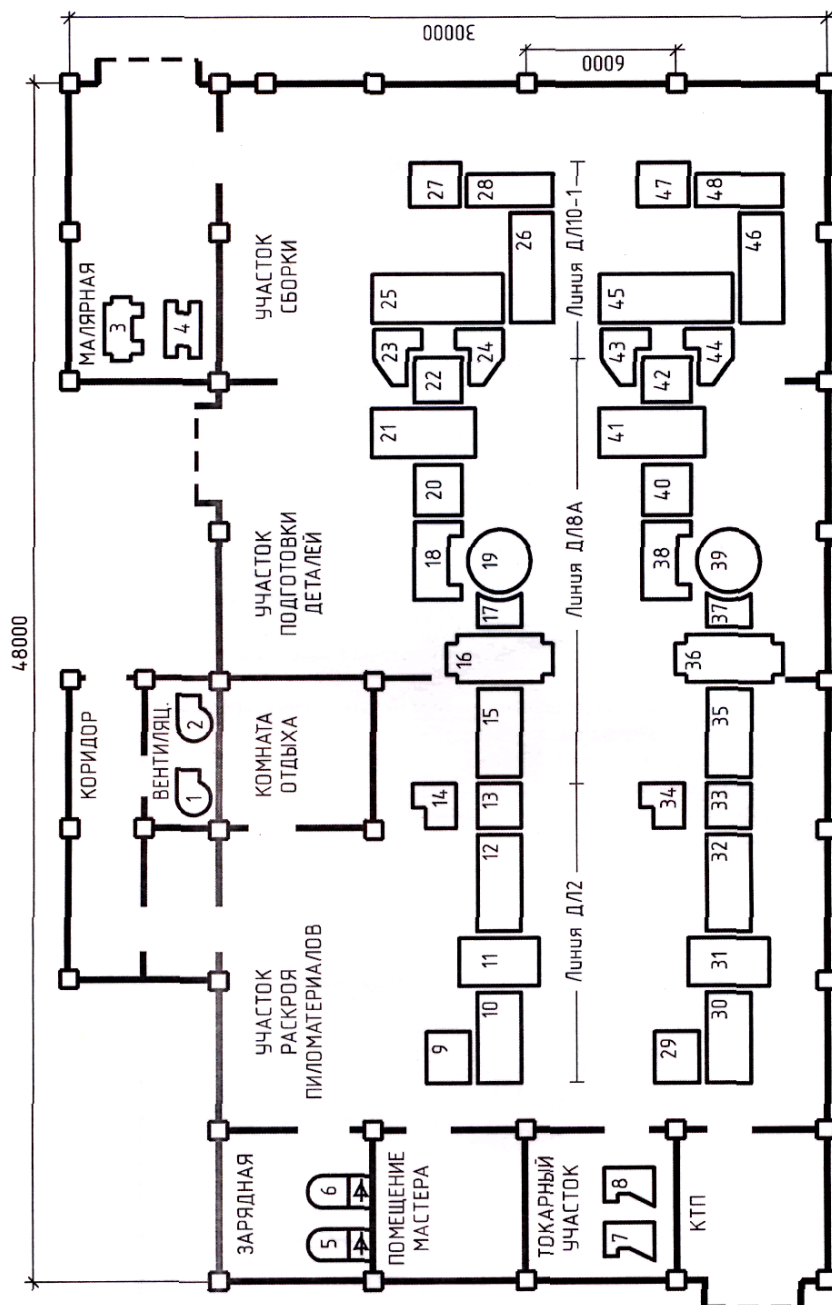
План расположения ЭО деревообрабатывающего цеха
